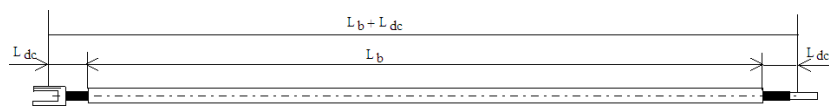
Longueur de la Barre avec Dispositif de Connexion[NGU09]
